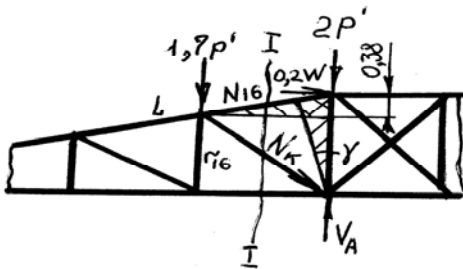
Схема к расчету усилий в стержнях 15 и 16
